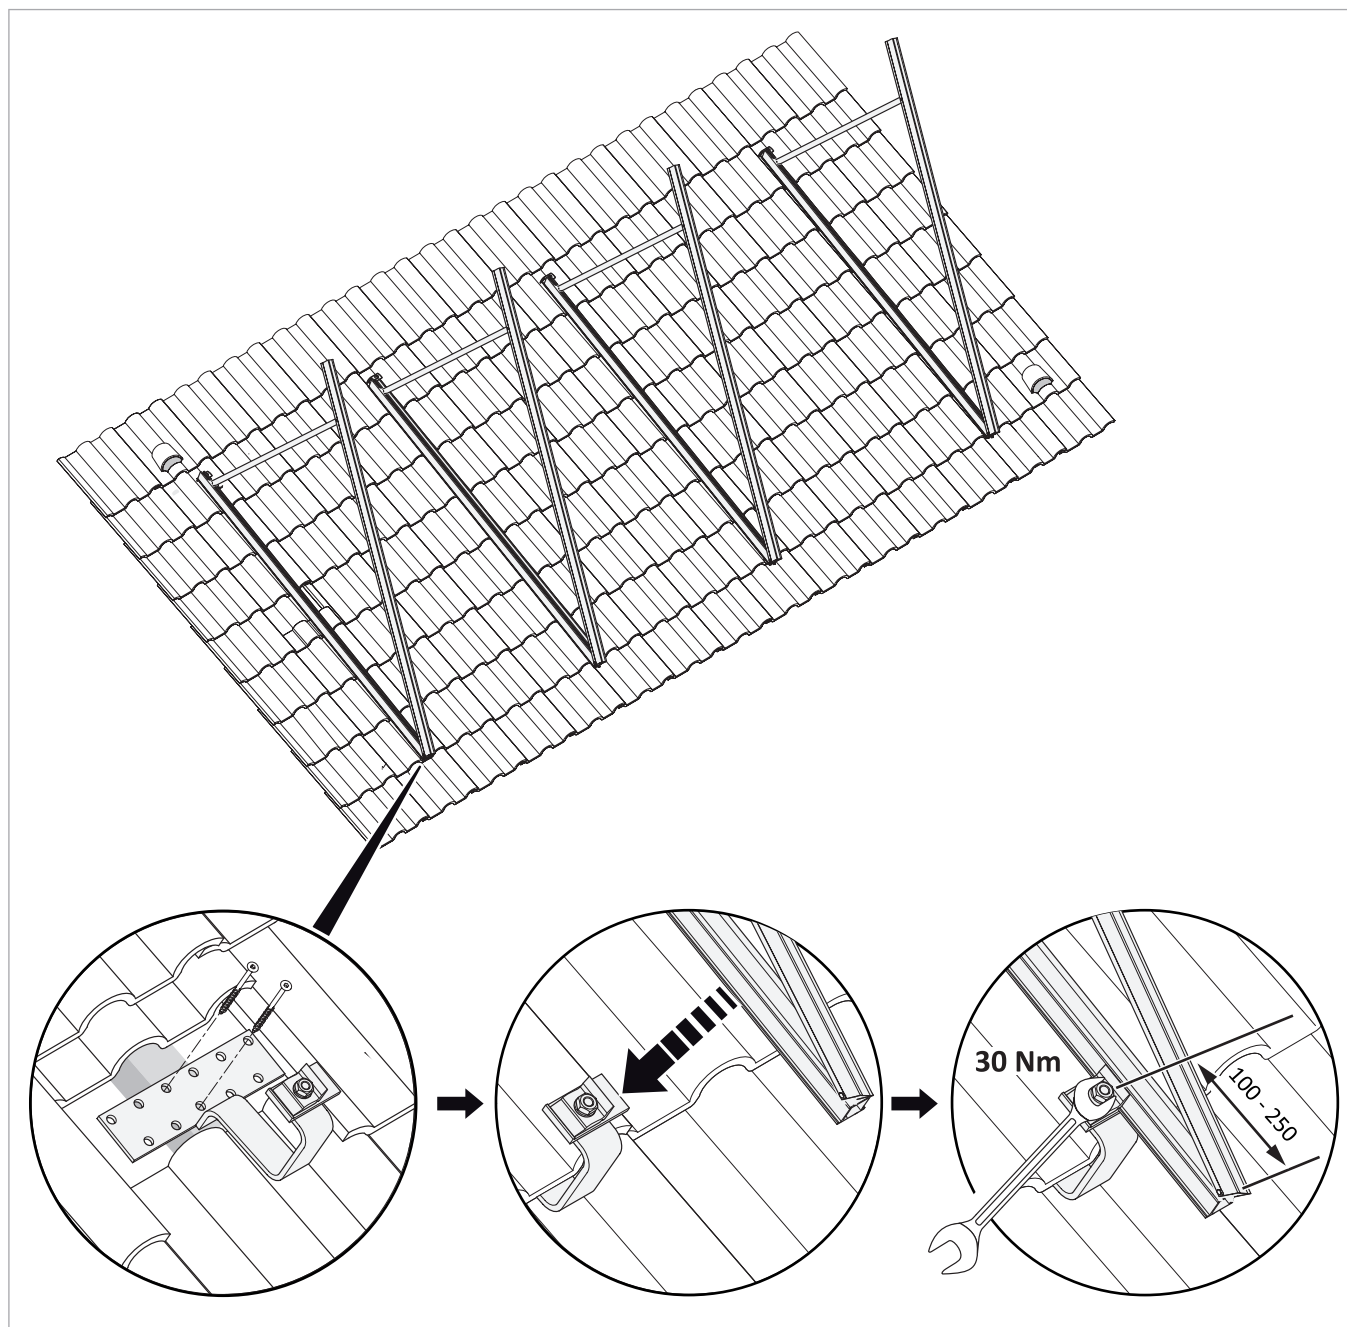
Montaje del soporte para tejado plano en el soporte sobre tejado ADH-U
